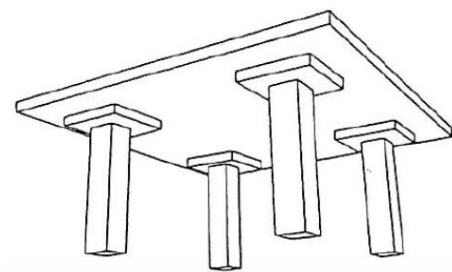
Losa postesa con capiteles o ábacos.
